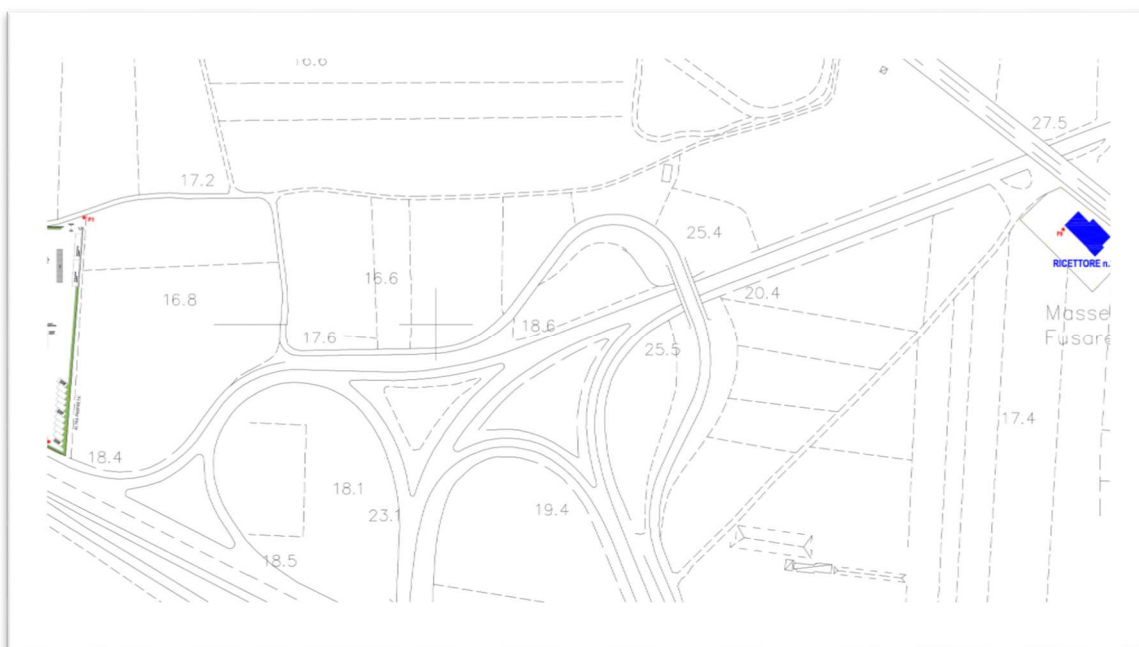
Stralcio planimetrico con individuazione del ricettore n.3
